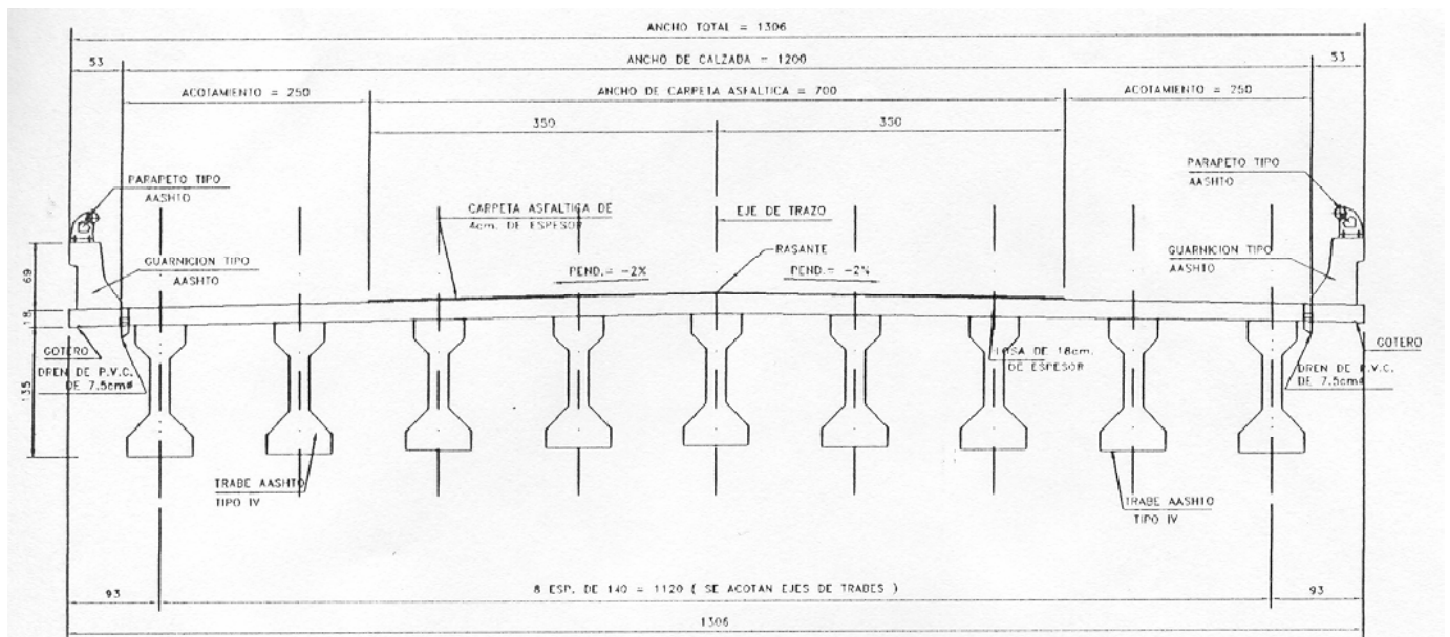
Ejemplo de sección transversal típica de un puente en construcción.
